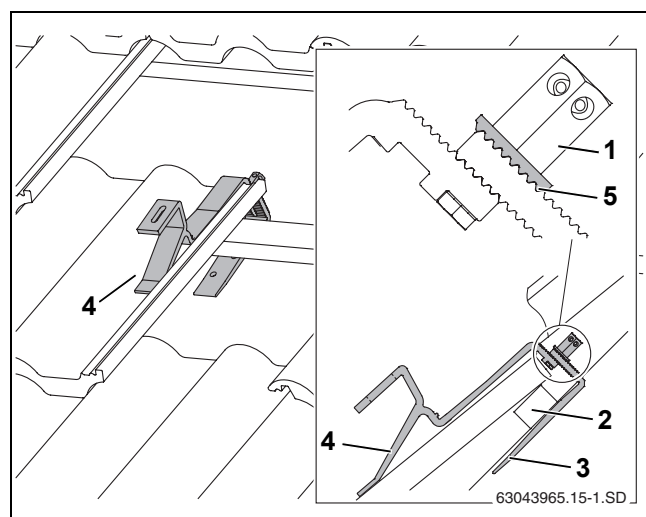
Gancho de tejado enganchado (para facilitar la vista se han eliminado de la figura algunas tejas)
